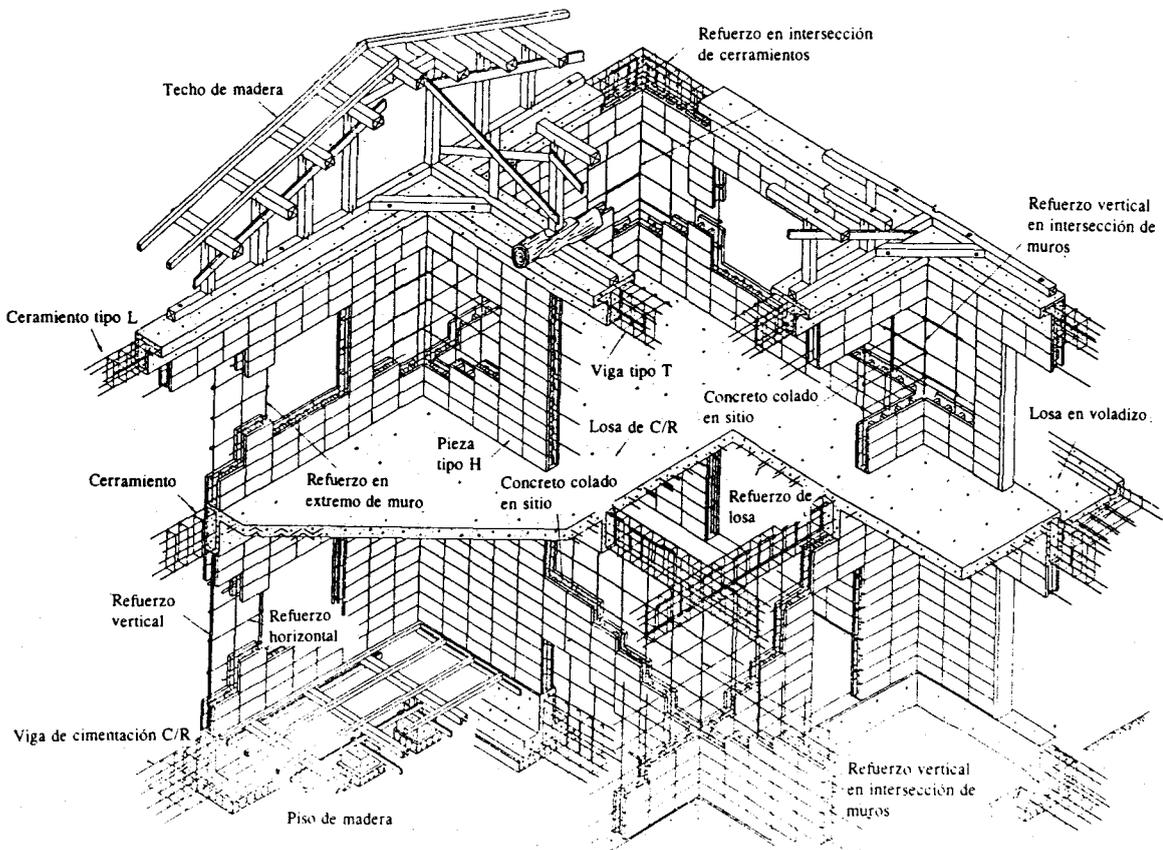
Ejemplo típico de un sistema estructural TIPO-1 SGM
